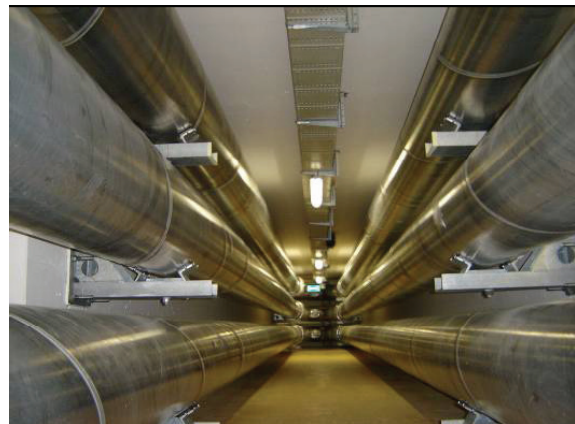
b: GIL in Tunnelverlegung (Genf)
